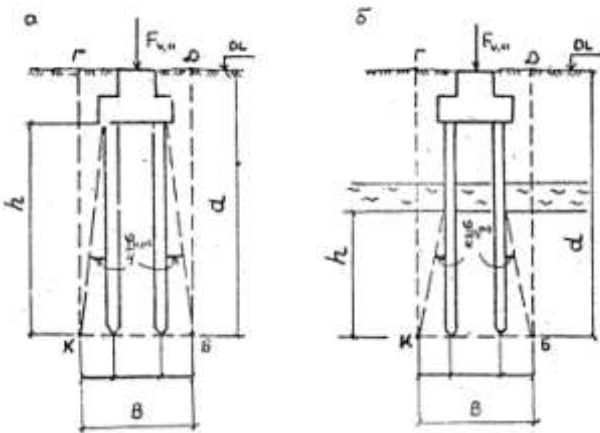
Схема определения условного фундамента: а – при отсутствии слабых грунтов; б – при наличии слабых грунтов толщиной более 30 см.
